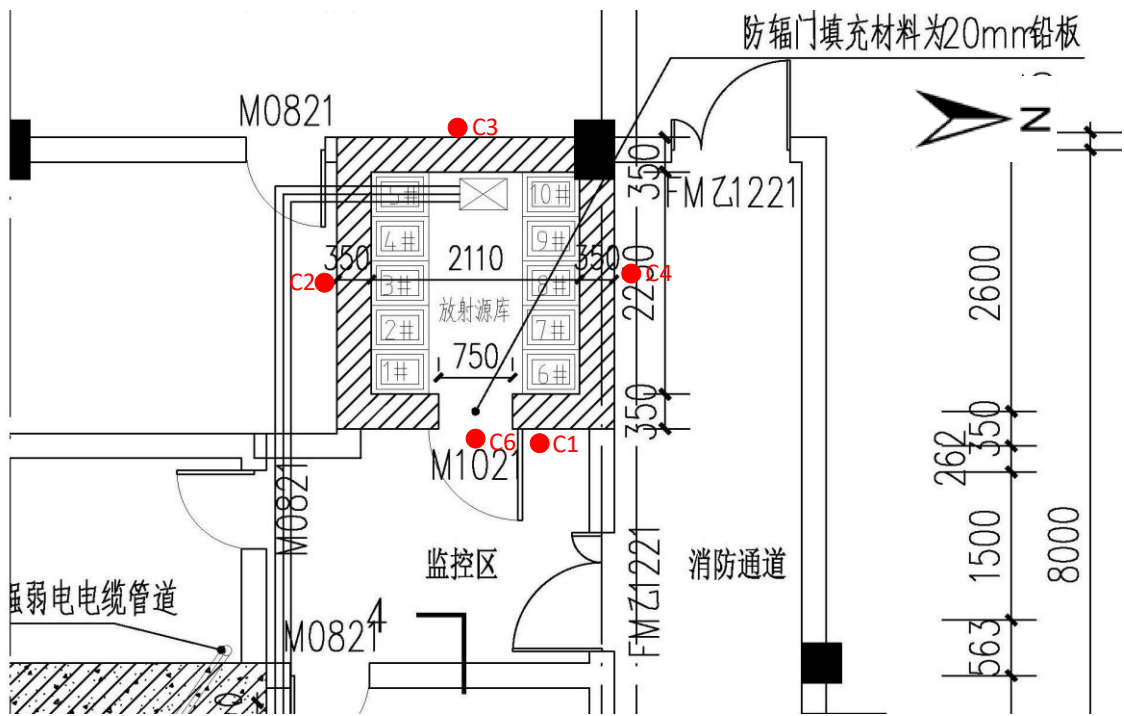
放射源库平面布局及预测点位示意图（单位：mm）
